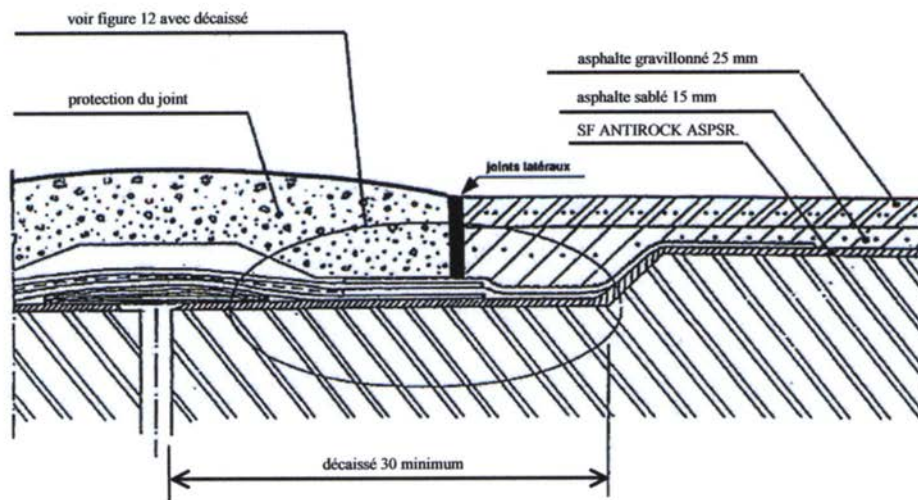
Raccordement à un revêtement asphalté Toitures accessibles aux piétons et aux véhicules légers (protection en asphalté) [par ex. : type 15 + 25]
